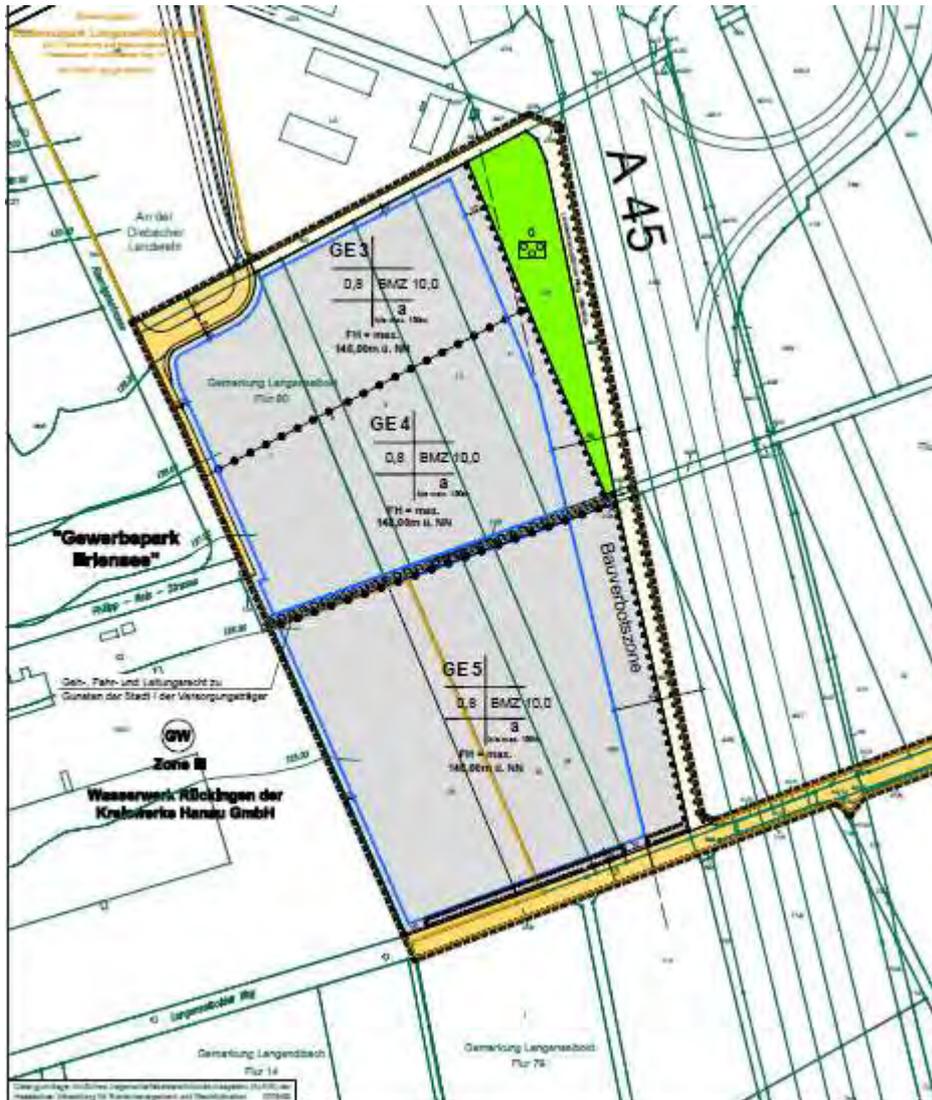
Ausschnitt Entwurf B-Plan [3]
